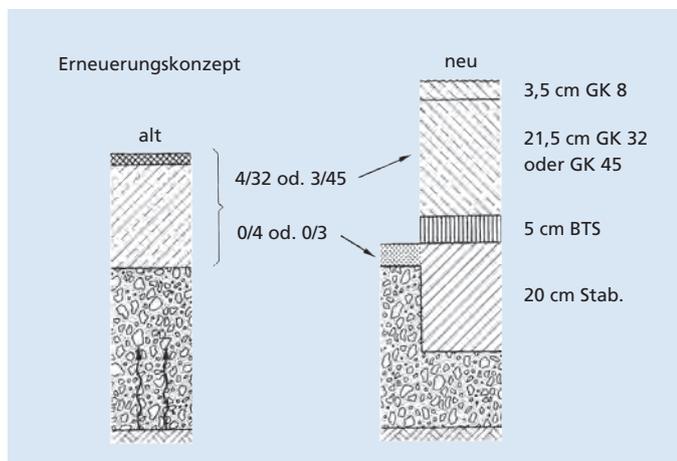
Erneuerungskonzept für die Betondecken der A1 Westautobahn (Vorschlag 1990, heute Waschbeton GK8 mindestens 4 cm dick und Unterbeton stets GK32)
